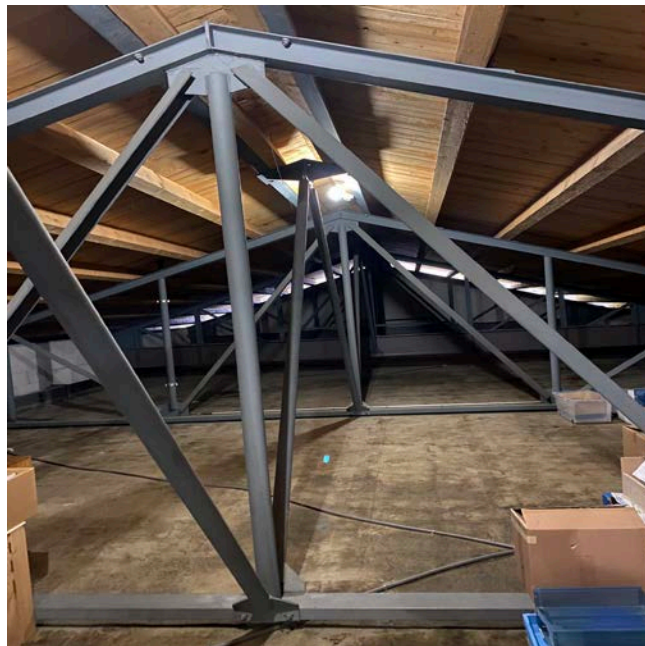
Fachwerkskonstruktion Dachstock Etappe 1 und Etappe 2
